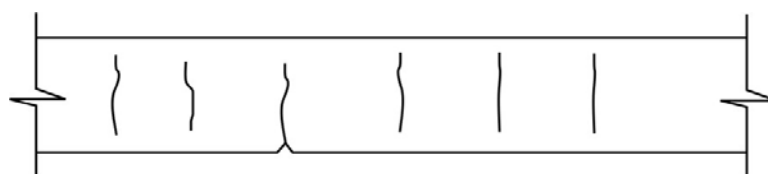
Típica forma de fissuras em viga de concreto, particularmente nas posições dos estribos. Geralmente estas fissuras são acompanhadas pelo destacamento da camada de proteção (HELENE, 1993)
